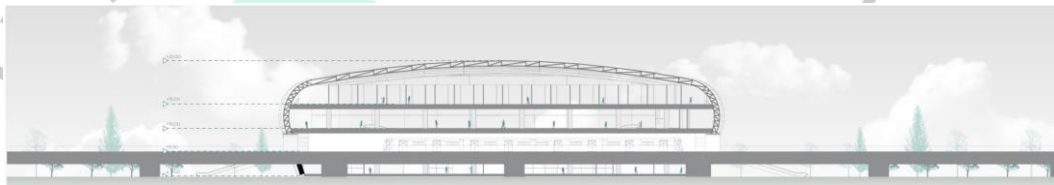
10 Potongan AA Bangunan Juanda Intermodal Hub
